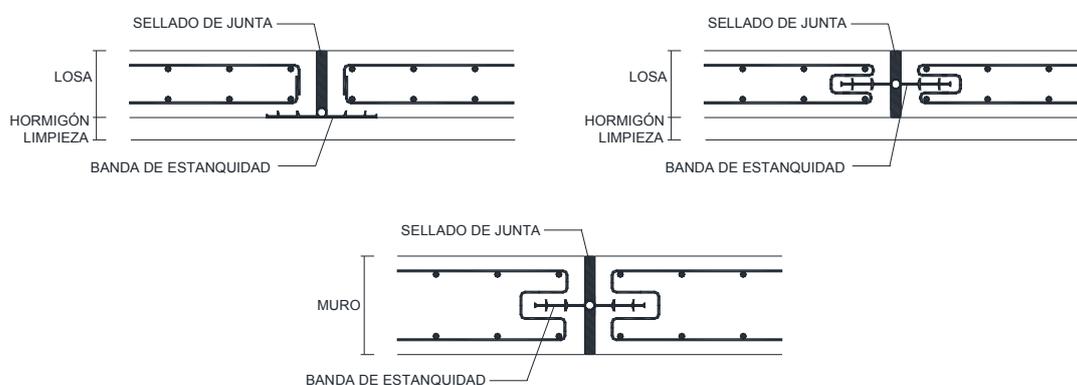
Detalle de junta de dilatación en solera (arriba) y en muro (abajo)
